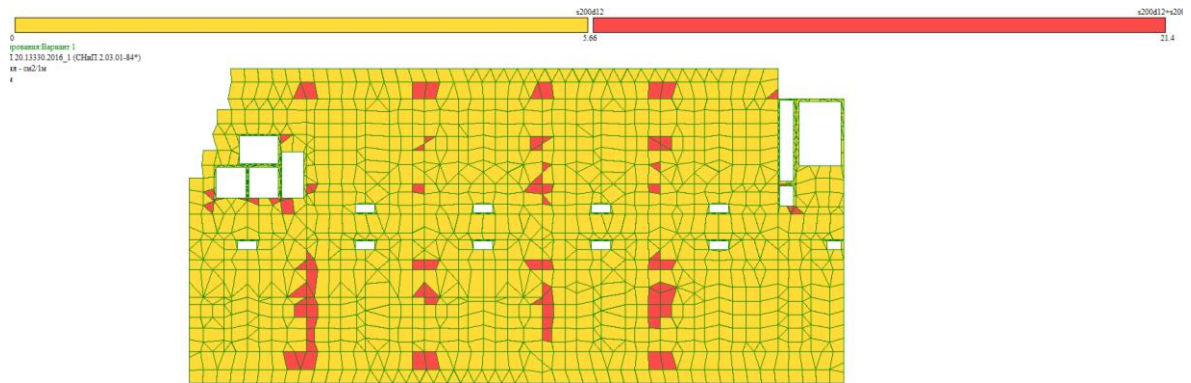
Подбор верхней поперечной арматуры плиты
